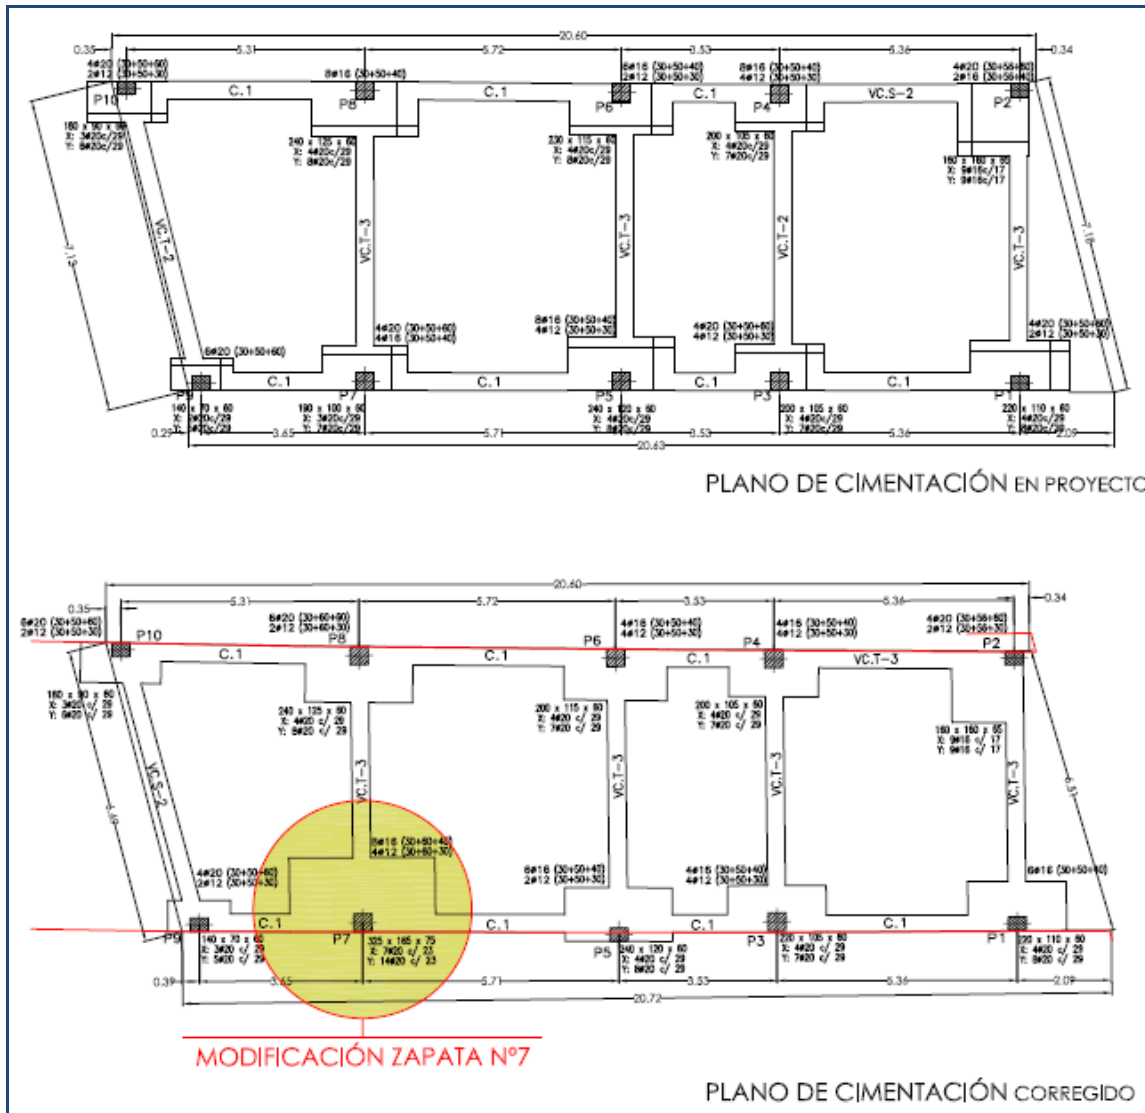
Comparativa entre el plano de cimentación en fase de proyecto y el plano corregido.
